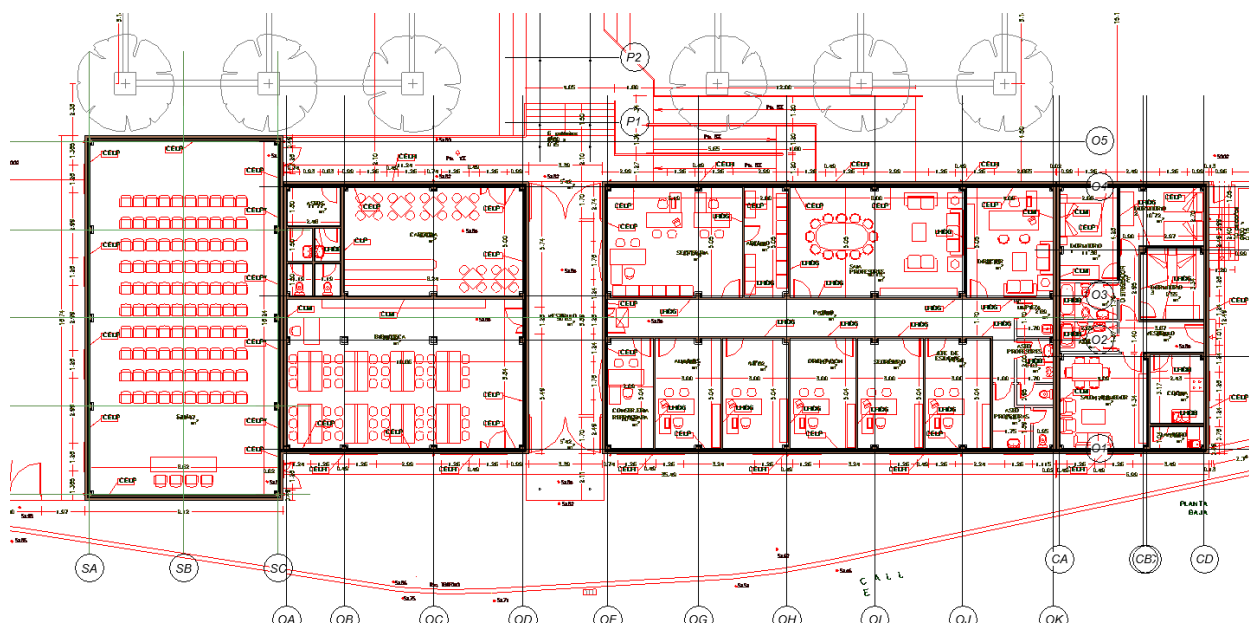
Vista en planta con CAD importado del proyecto real para la creación de cerramientos
